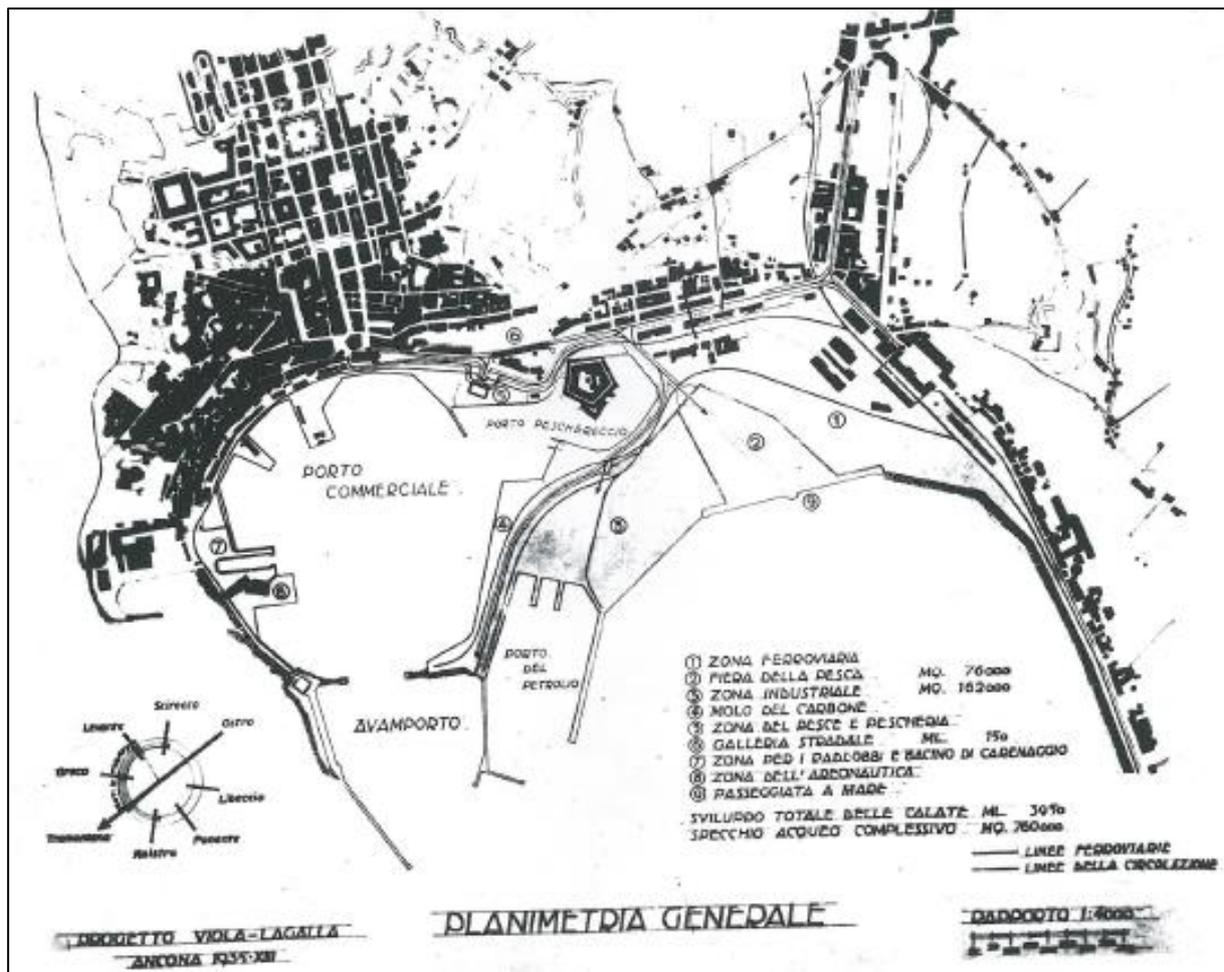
Planimetria generale, Progetto Viola - Lagalla, Ancona 1935.
